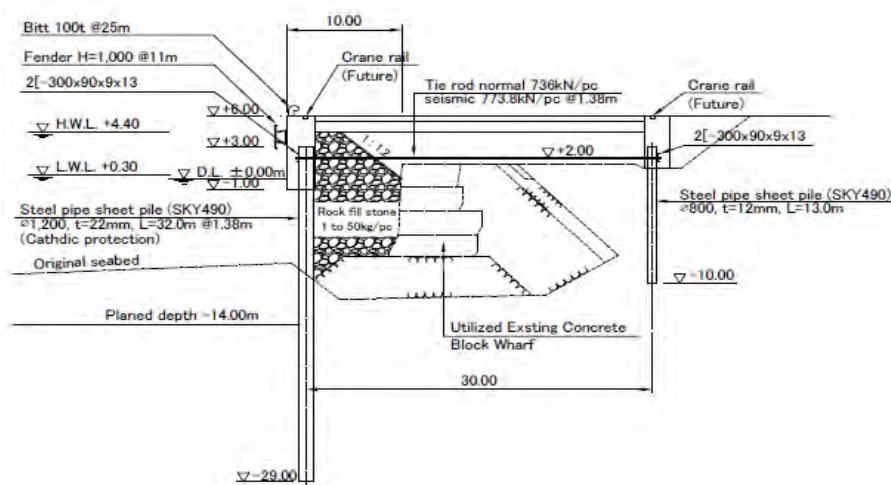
Viga de chapa em tubulações de aço no lado norte (40m de alargamento)
